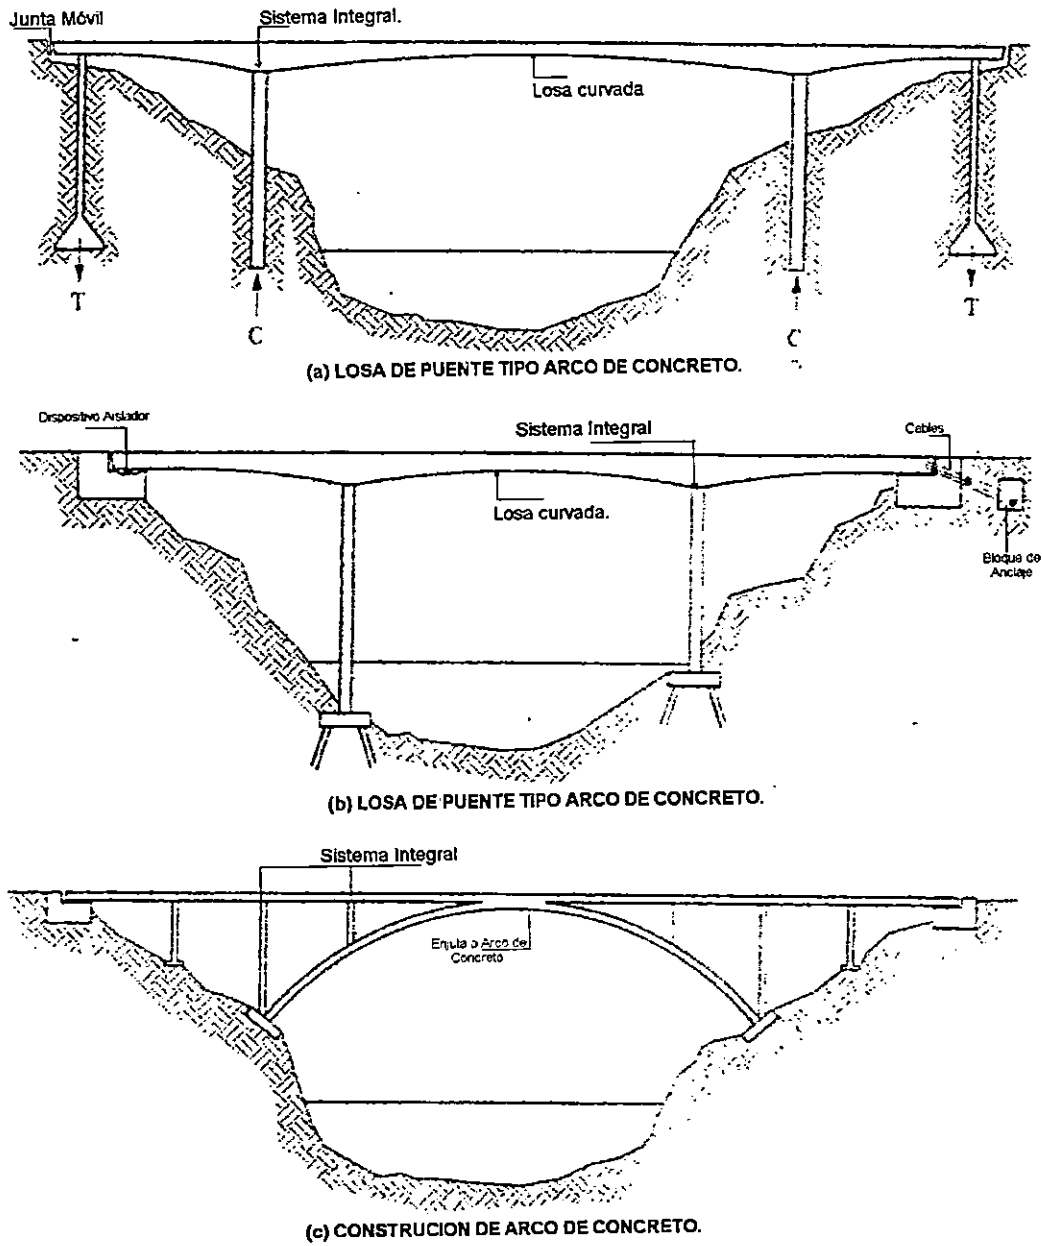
PUENTES DE ARCO CON CONCRETO REFORZADO.
